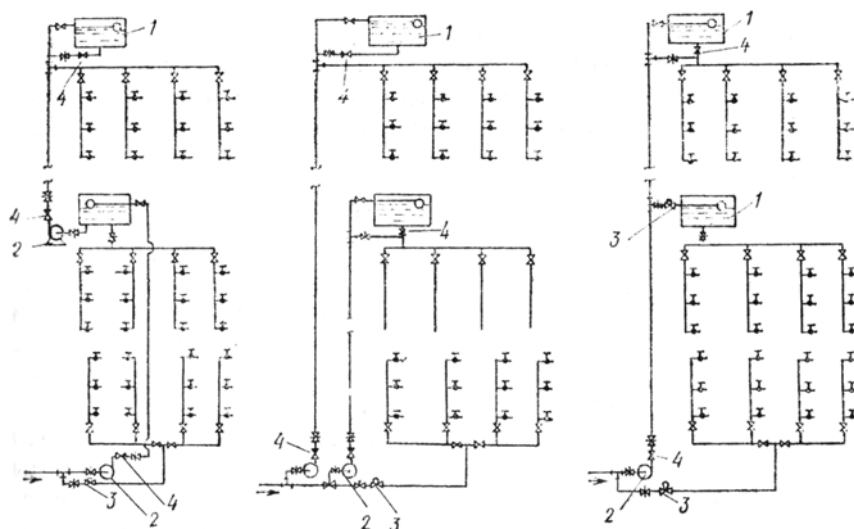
Схемы зонного водоснабжения высотных зданий:
